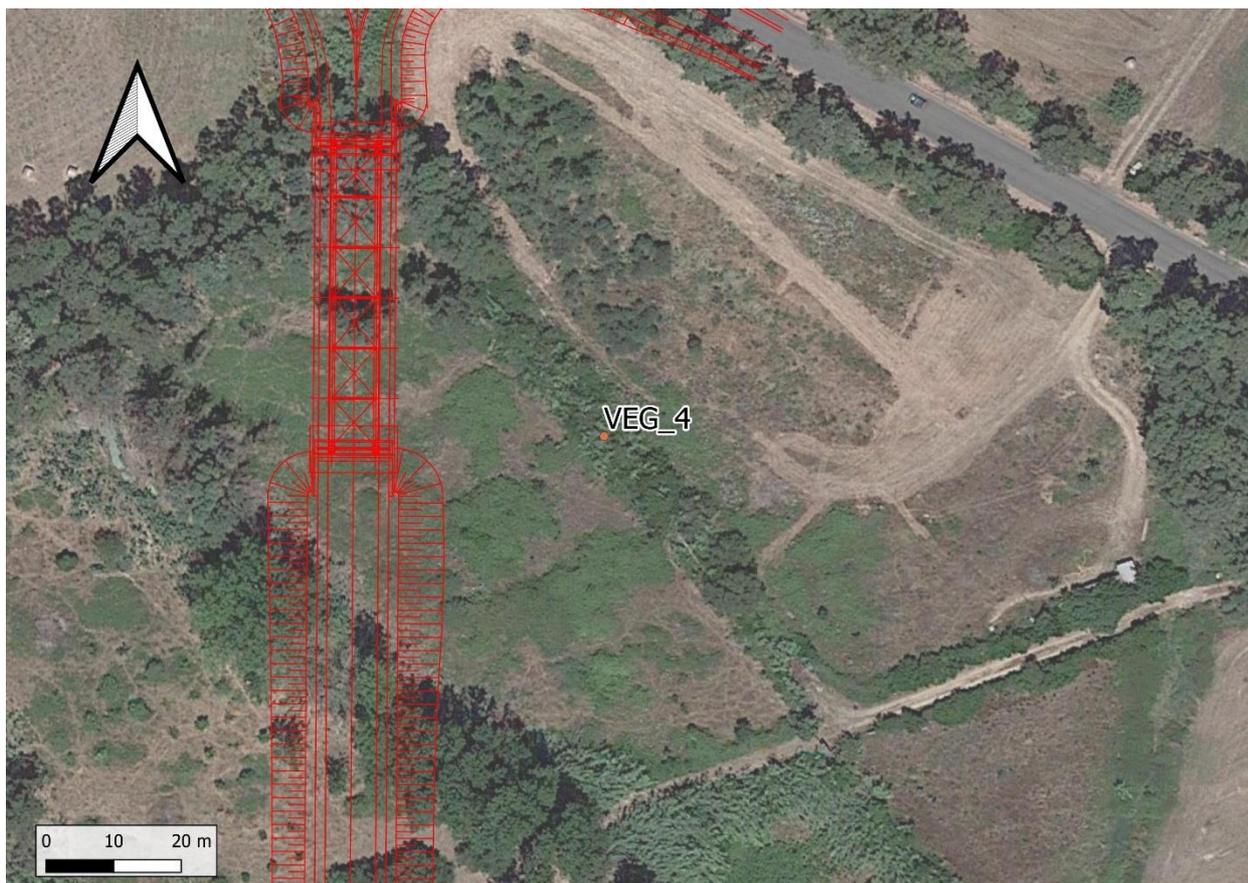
Localizzazione punto rilievo VEG_4 rispetto al tracciato di progetto
